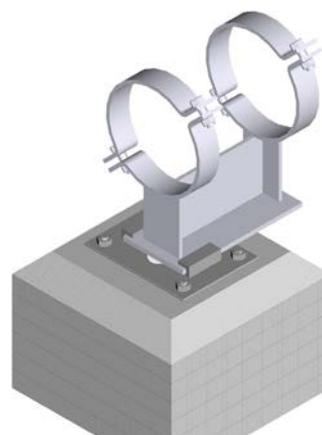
Führungslager SA 150H mit PTFE-Gleitplatte KS 34703 auf Betonfundament
